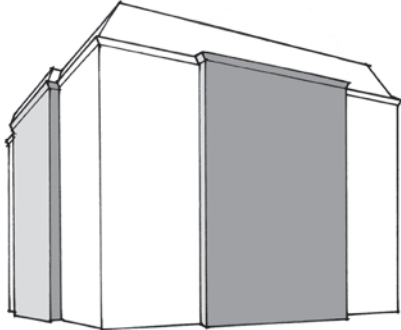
Risalit (hier als Mittelrisalit an der Straßenfassade und der seitlichen Fassade)
